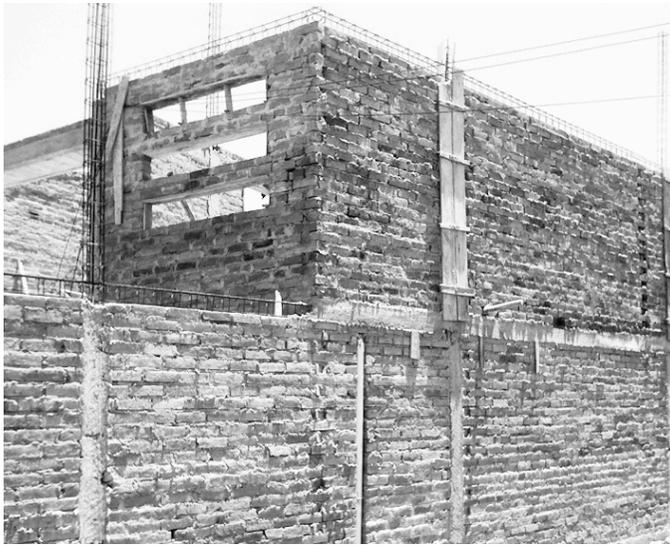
Vivienda construida en mampostería confinada del modo tradicional.
